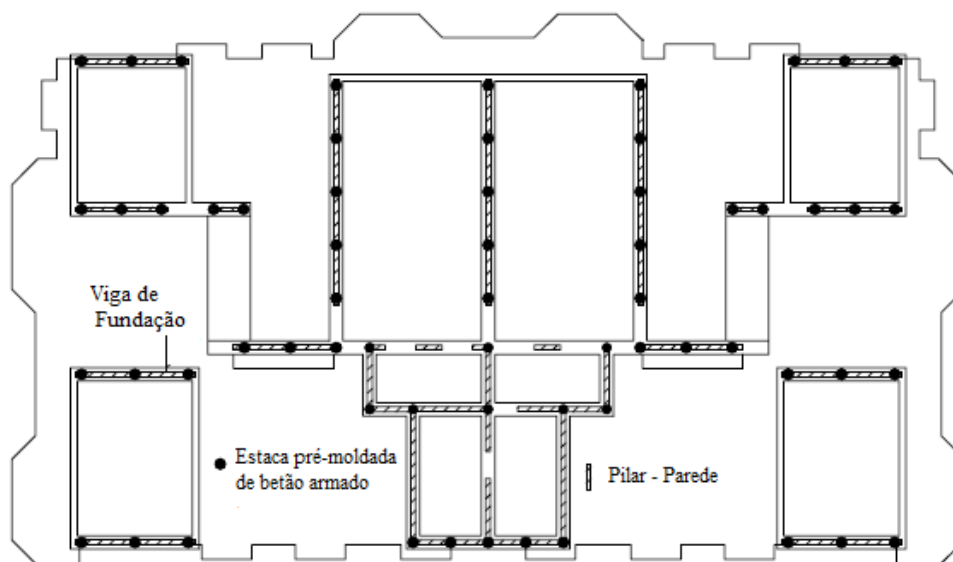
Planta de fundações do bloco “B” do condomínio “Anêmona” (Maffei Engenharia, Gimenez de Souza, 2003).
